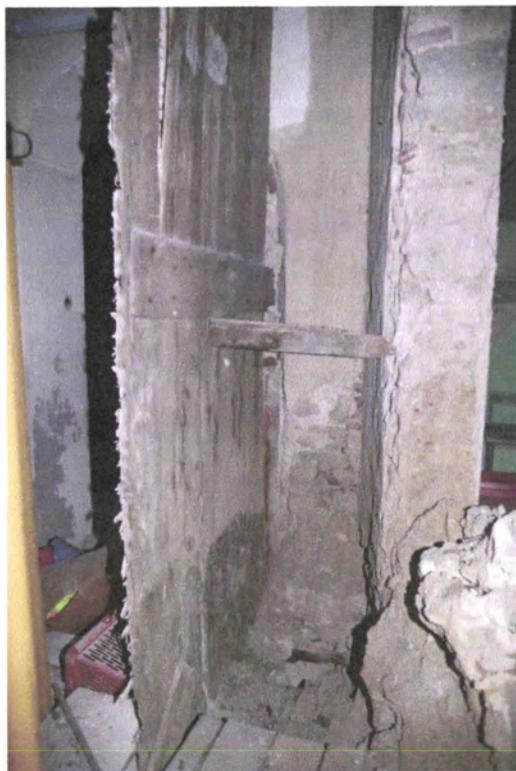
Foto da autora. Parede interior em alvenaria de pedra e em tabique.
